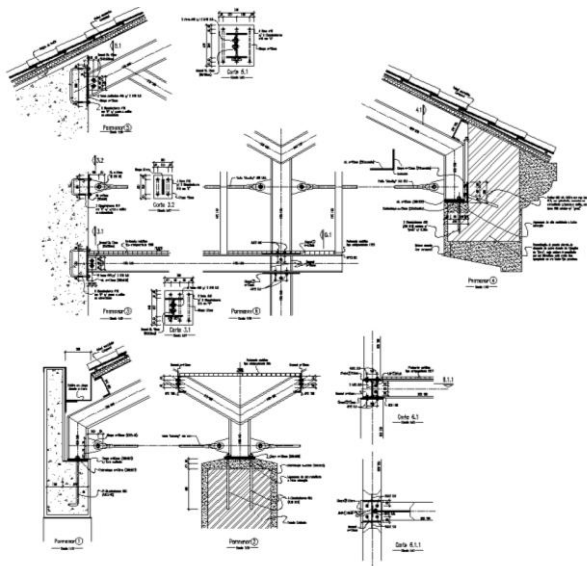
Pormenores das ligações das Asnas da Cobertura às paredes existentes e à nova estrutura em b.a.
